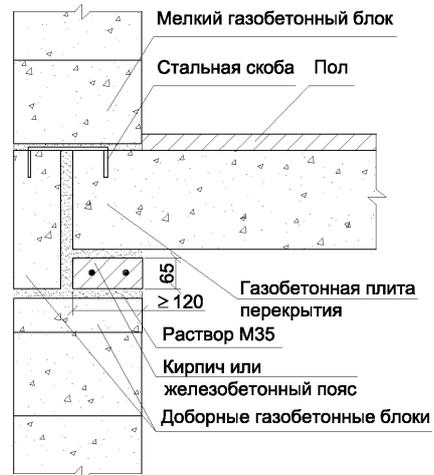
Опираие газобетонных плит перекрытия на наружную несущую стену из мелких блоков
